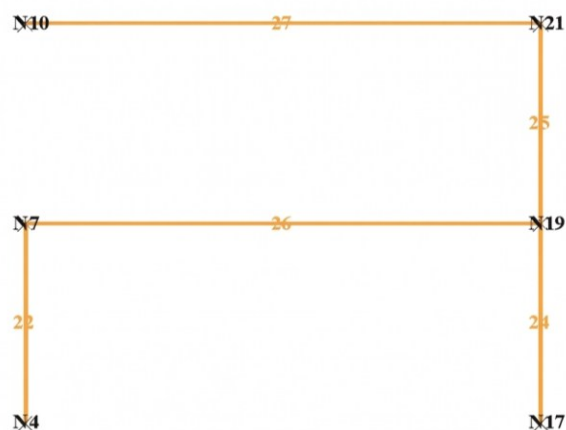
Prospetto Parete Fittizia 4 - Modello Isolato
